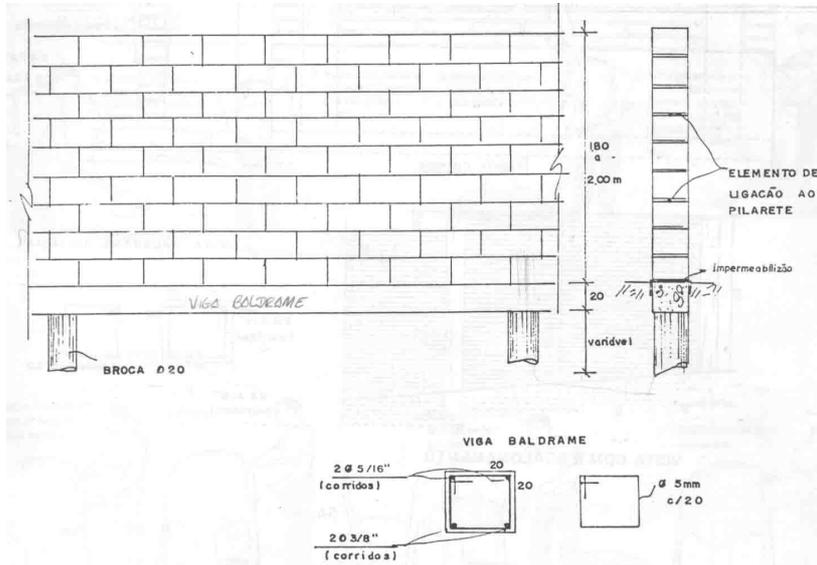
Esquema de montagem da parede de alvenaria e detalhe da viga baldrame.
